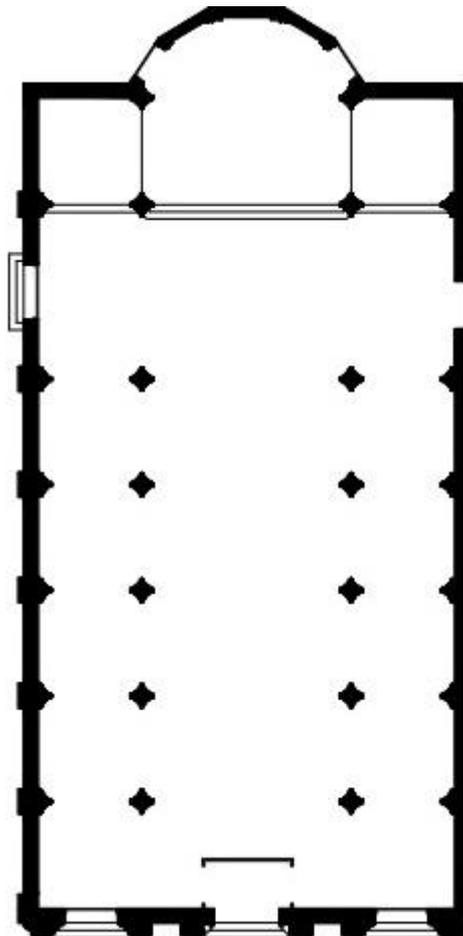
Planta esquemática da Igreja Nossa Senhora do Carmo do Rio Grande. Vivian S. Paulitsch, 2016.
